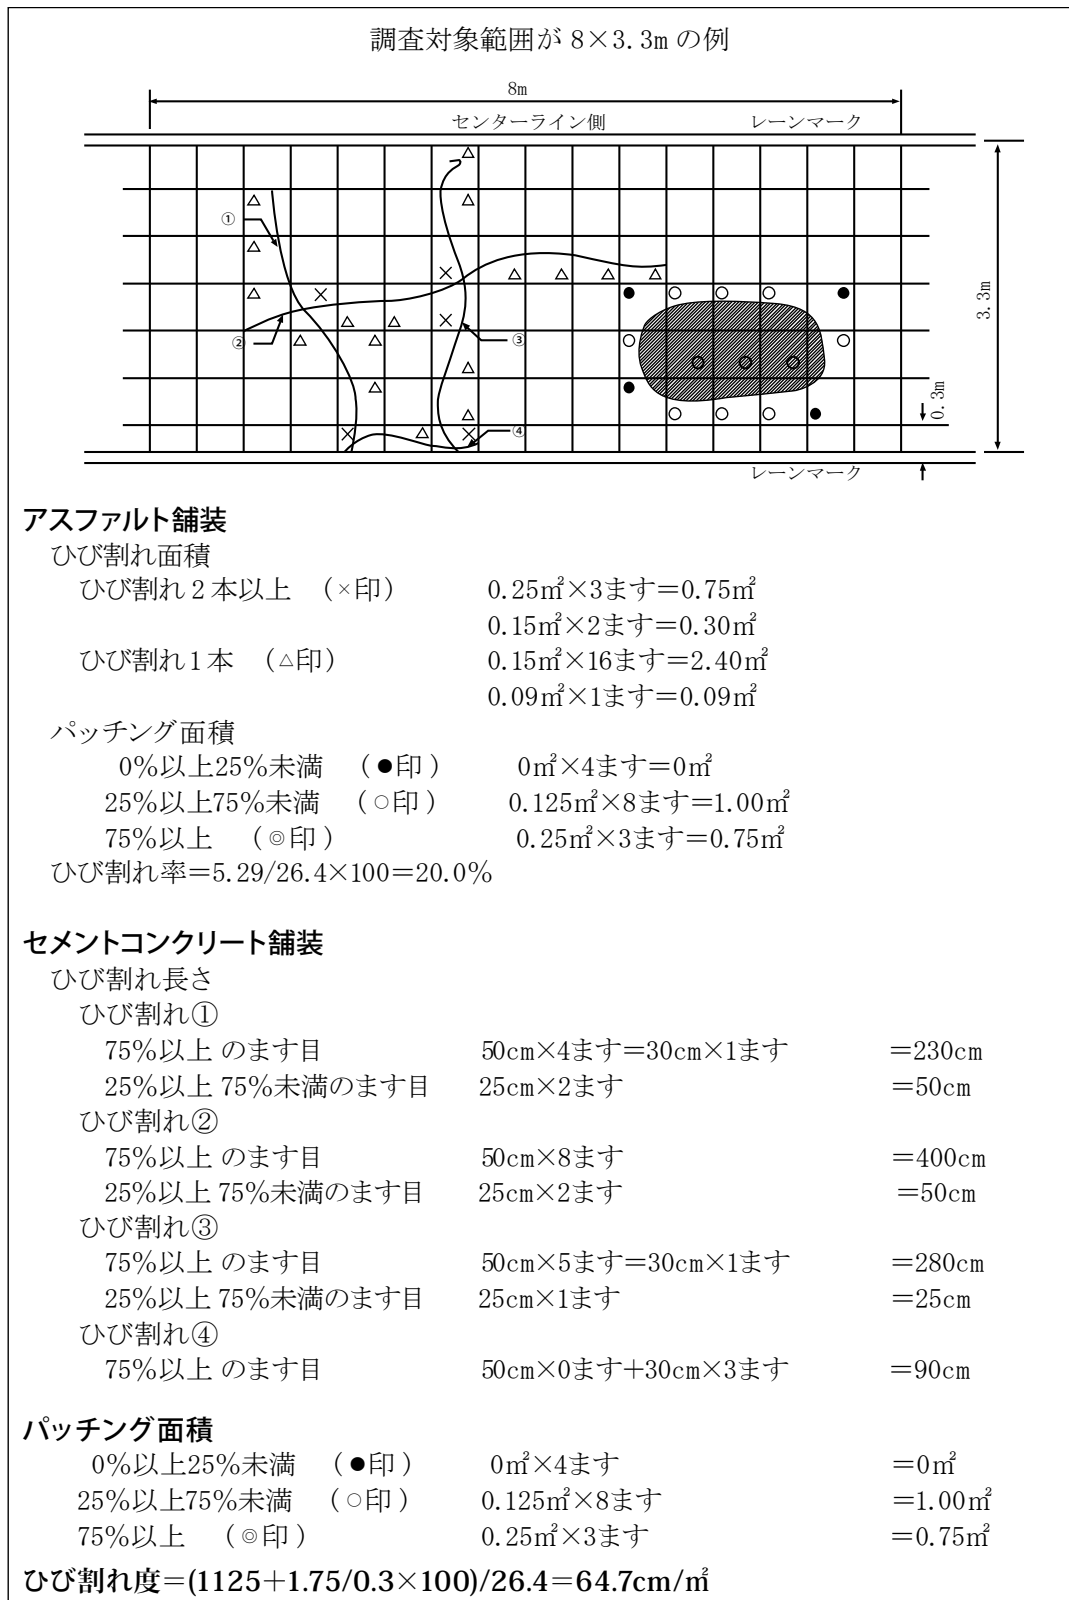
2 ひび割れ率及びひび割れ度計算例
